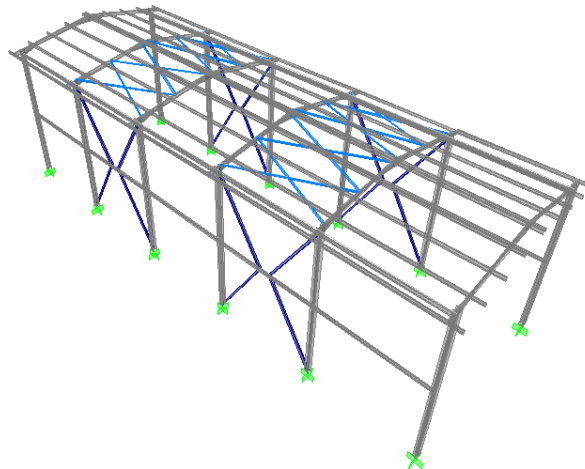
Galpón con arriostramientos Tipo 8. Vista Tridimensional.
